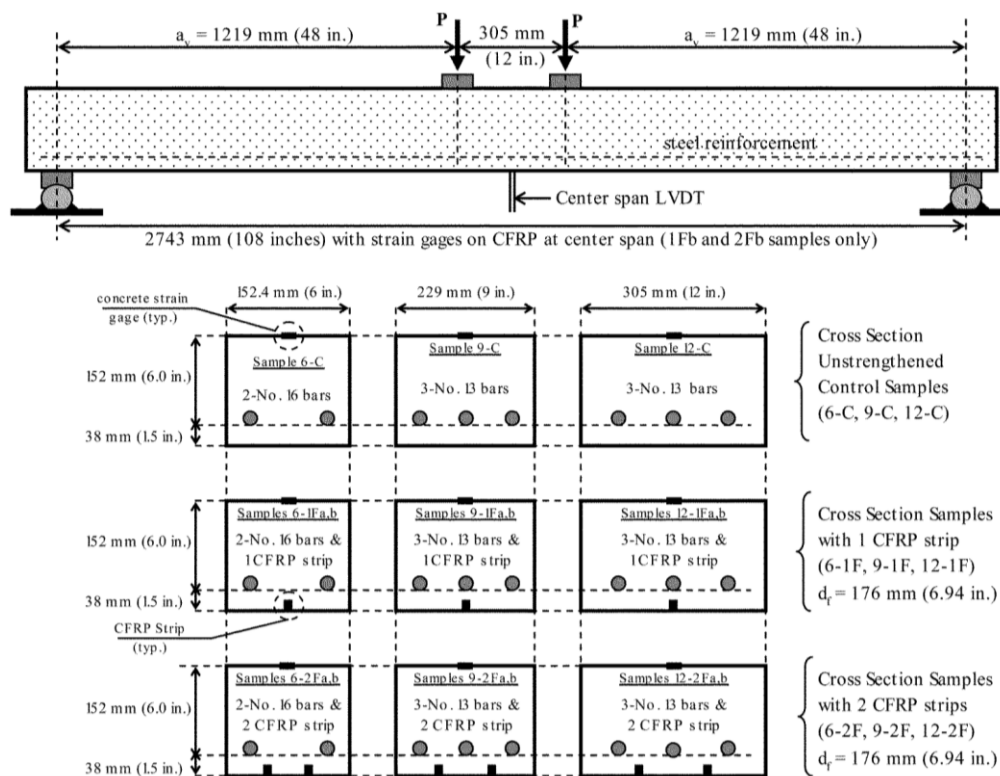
Geometria e distribuição do reforço das vigas de YOST *et al.* (2007)
